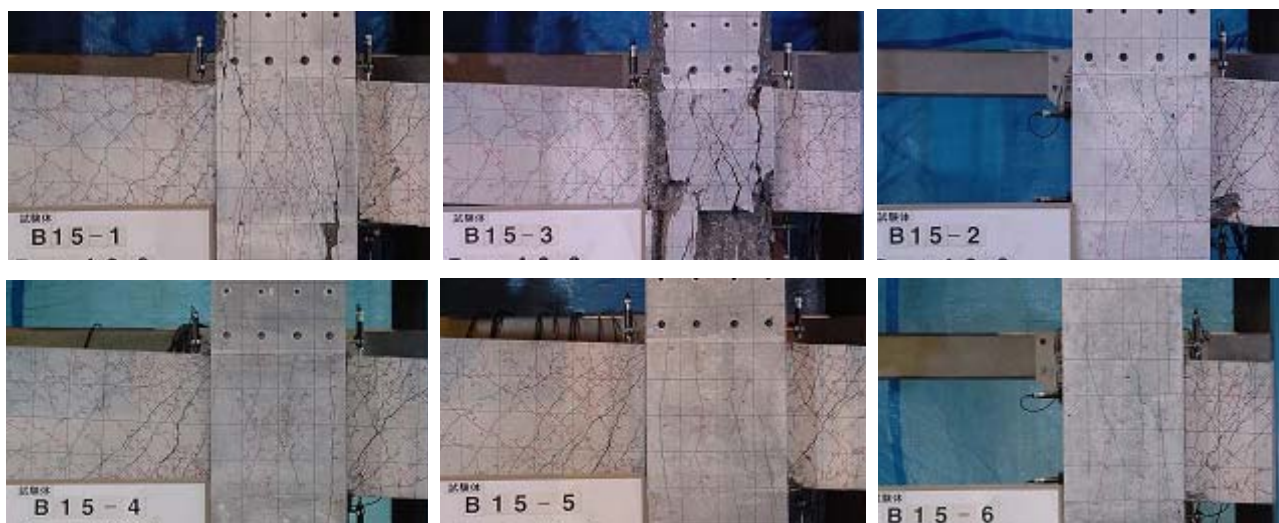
ひび割れ状況写真($R=+40/1000\text{rad.}$ 1 回目)
